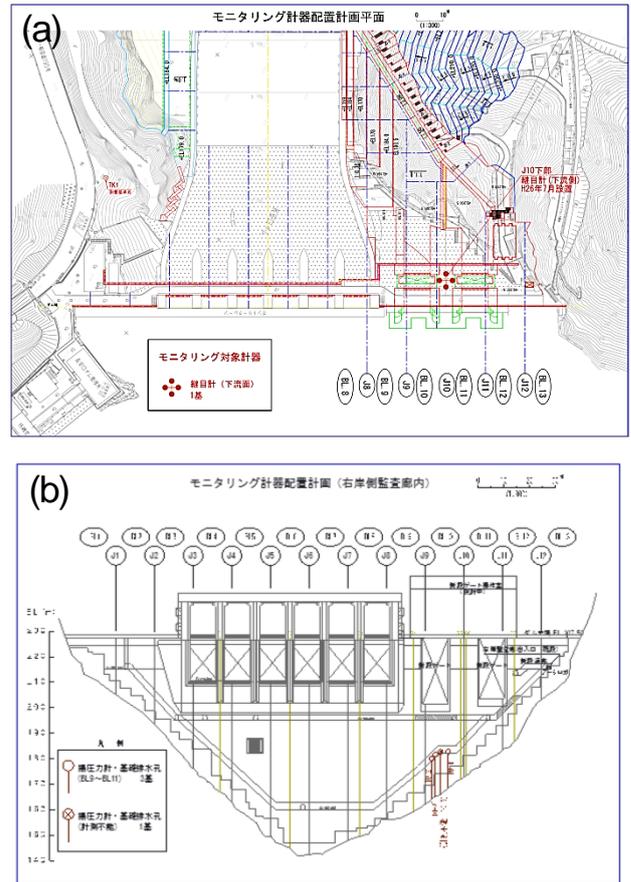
(a)モニタリング計器配置平面図及び(b)正面図
